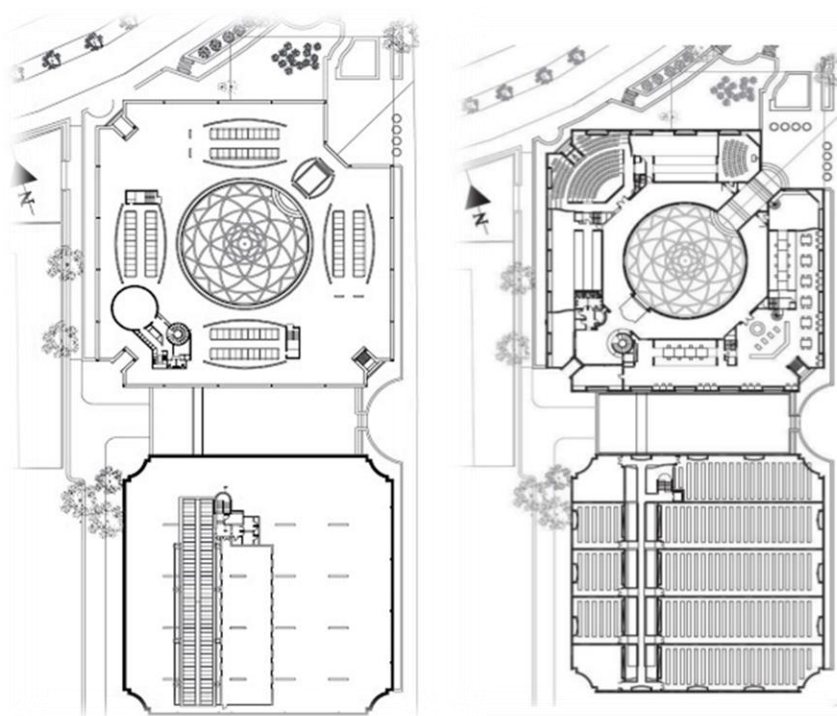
Plantas del Edificio del Archivo General de la Nación.
